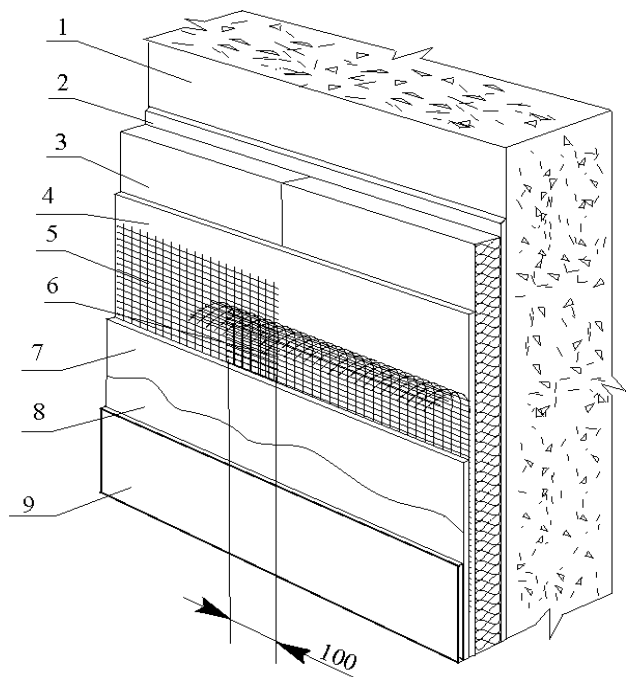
Схема соединения двух полотен стеклосетки на стене здания.
